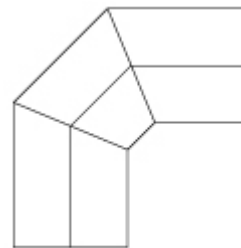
Ejemplos - Volúmenes Urbanísticos - Vista Planta
